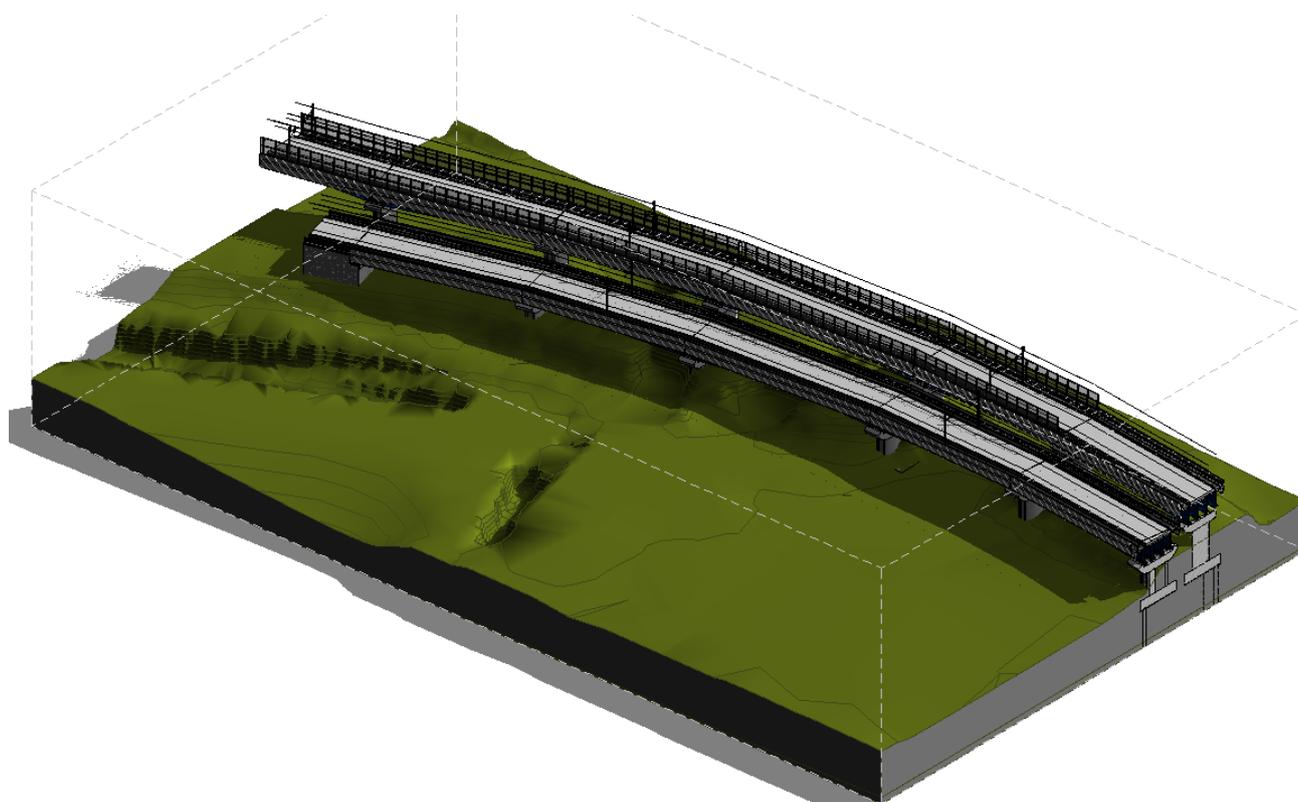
Vista prospettica - Ponte a struttura mista acciaio calcestruzzo a doppio binario
